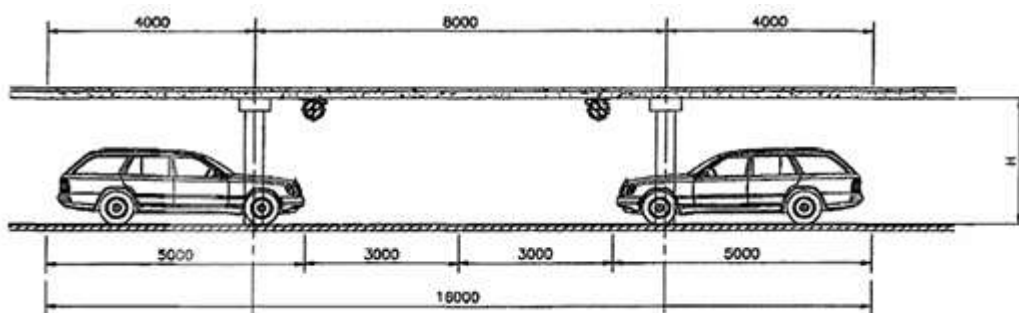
Расположение струйных вентиляторов над дорожным полотном, рядом с колоннами
